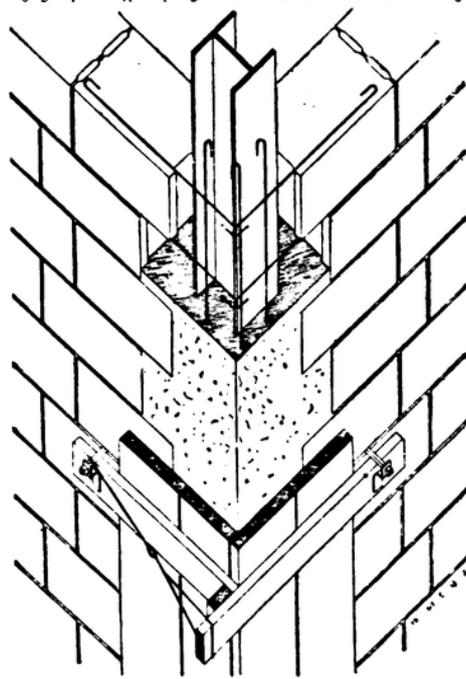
Emausbildung einer 10 cm starken Außenwand in Stahlkonstruktion mit Bimsbetonsteinen (Nach „Bauzeitung“, Stuttgart)
